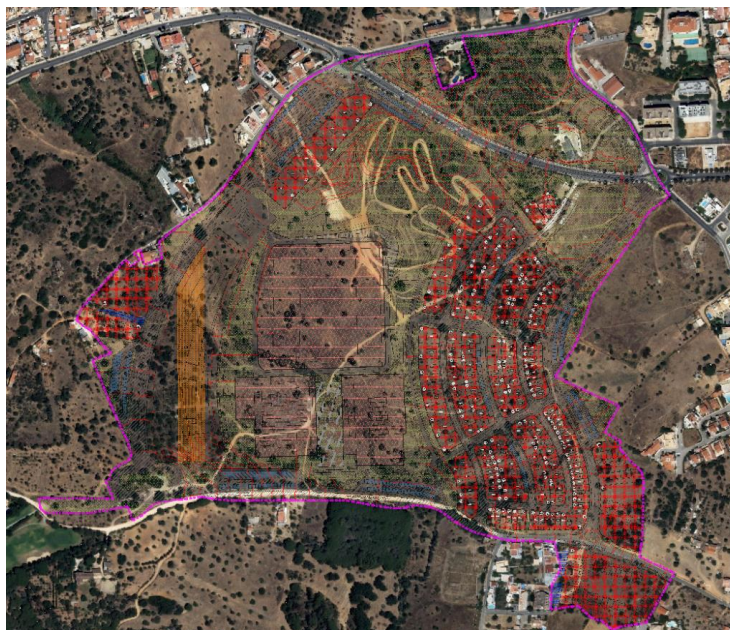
Planta de Implantação do PPBR. Fonte: Geo Portal da Câmara Municipal de Portimão
